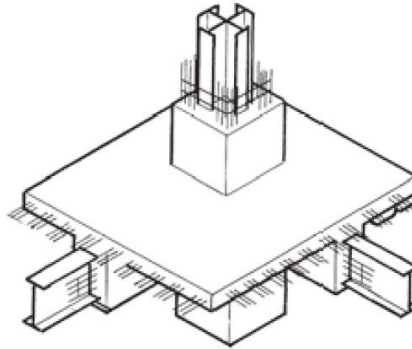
Exemplo de estrutura de quadro rígido de concreto armado com estrutura de aço
